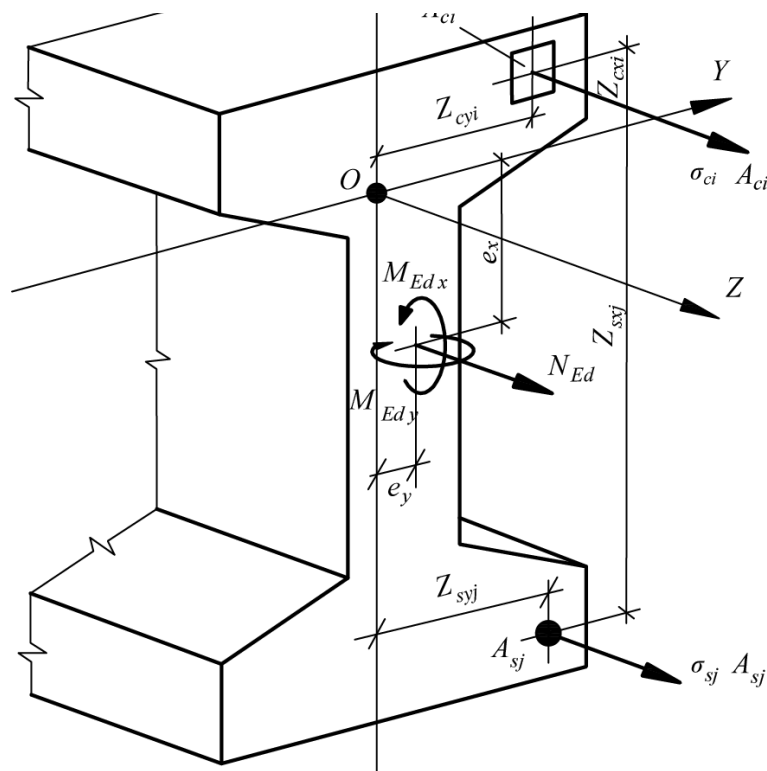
Расчетная схема нормального сечения железобетонного элемента
